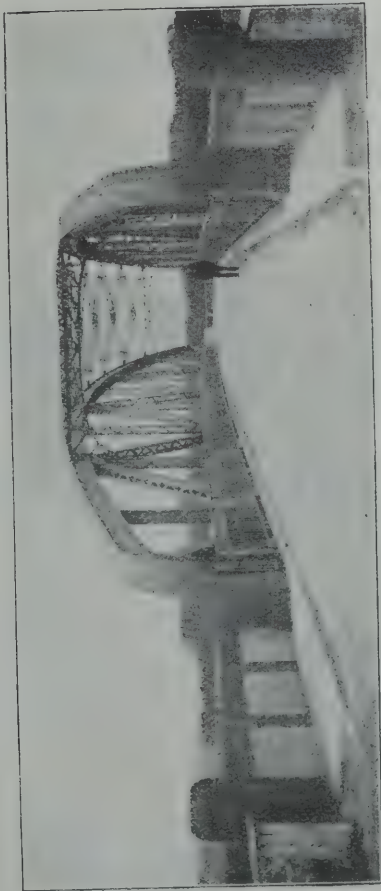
Straßenbrücke (Halbparabelträger mit gleichmäßig gekrümmtem Obergurt und starker Abrundung nach den Endpfosten)
